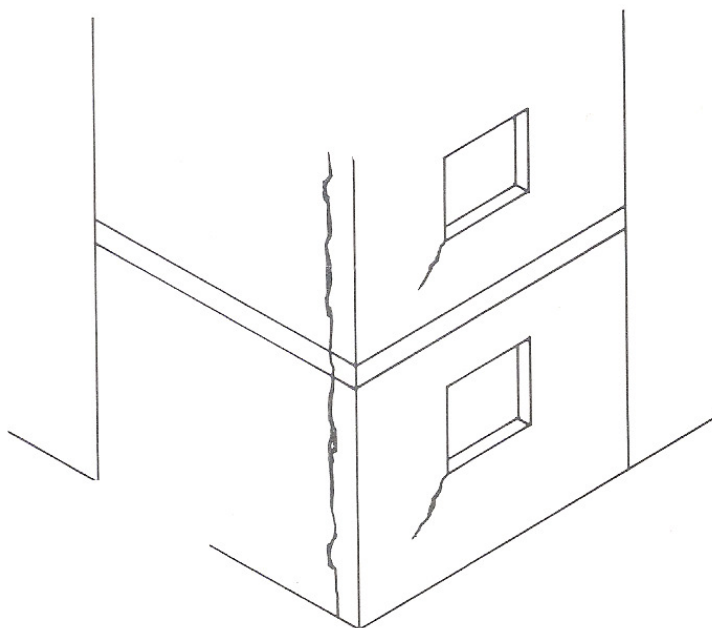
fissuração vertical da alvenaria no canto da obra provocada por movimentações higroscópicas (THOMAZ, 1990, p. 38)
